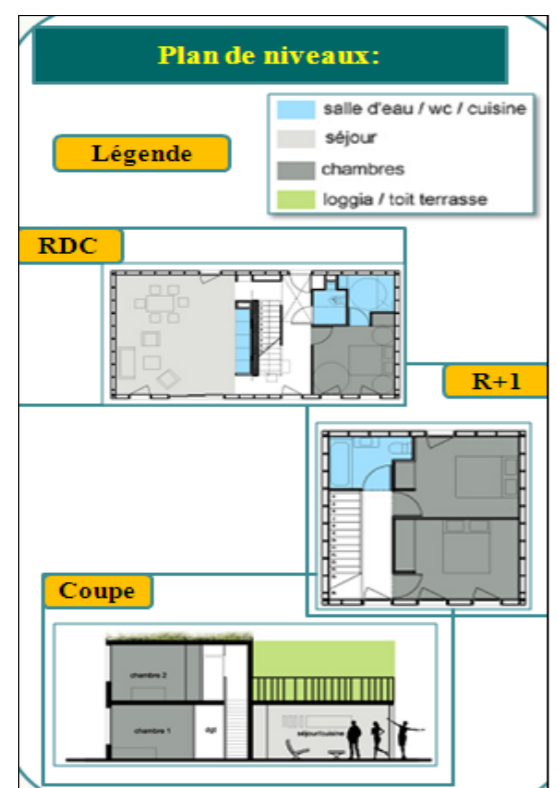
Plan RDC ; R+1 ; coupe d'une unité du logement Individuel Groupé
